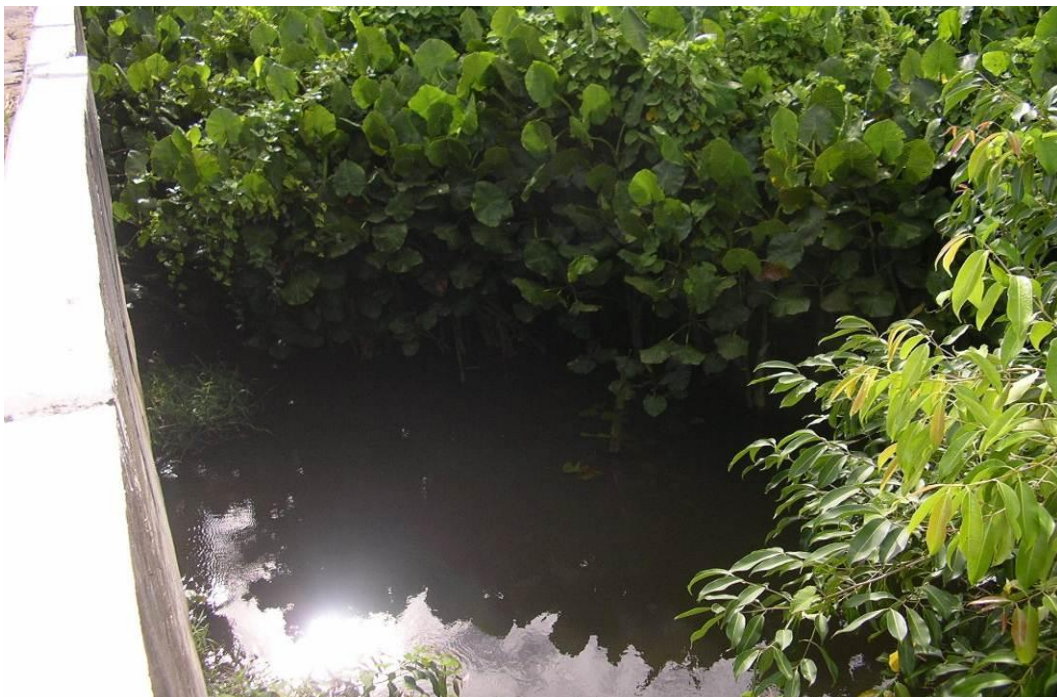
Estação PI-12, após o início das obras para construção da galeria para escoamento das águas do rio Pitimbu (ano 2012).
